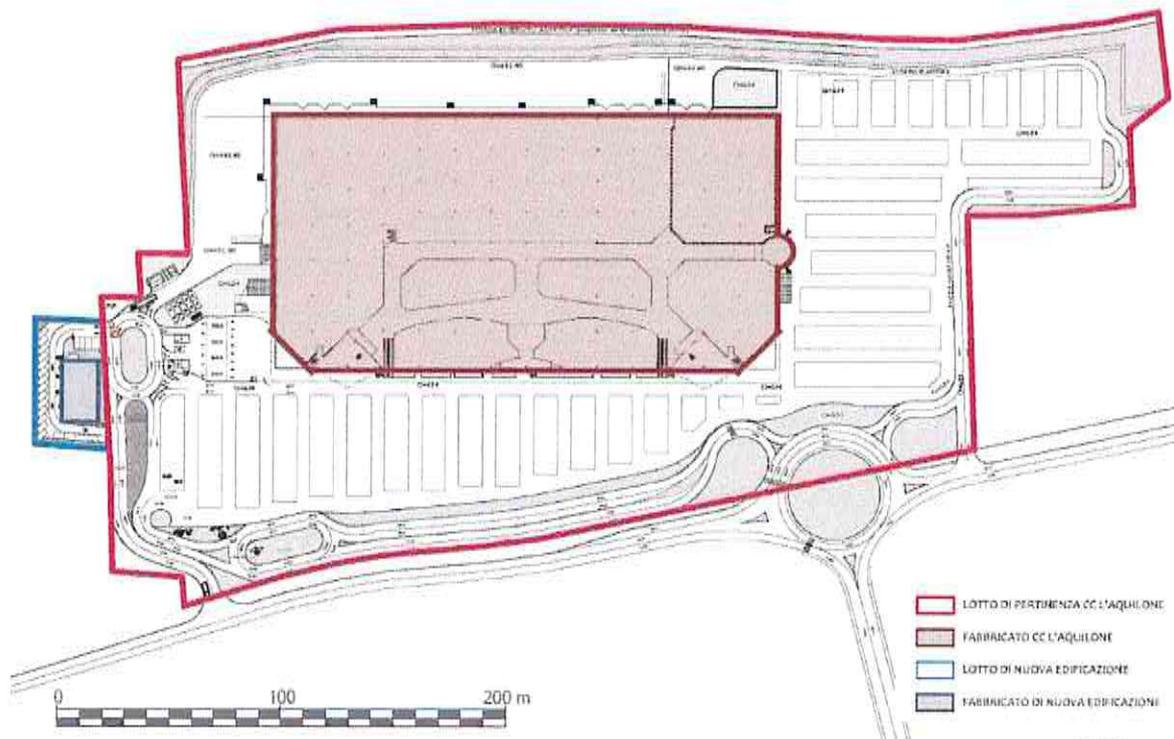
Planimetria generale dell'intervento con viabilità e parcheggi
